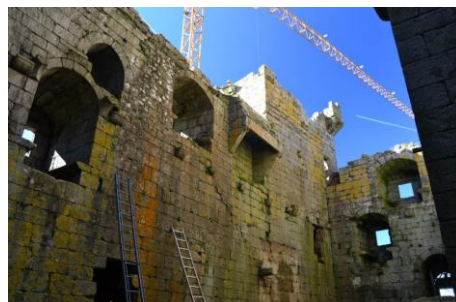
Chimenea a nivel de planta segunda anexa al muro perimetral de la fachada sur en el castillo. En el muro del fondo dos ventanas con parladoiro y la puerta de acceso al segundo recinto. Ídem.
